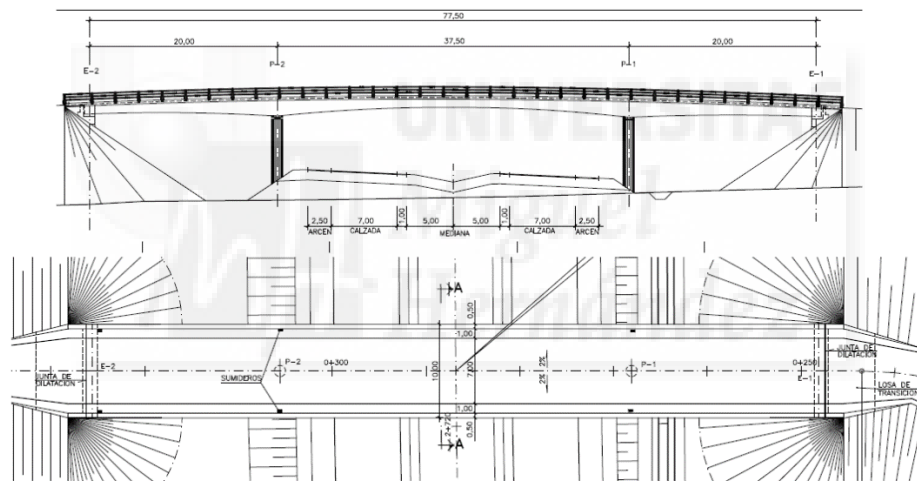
Planta y alzado de las estructuras 3, 4 y 5
